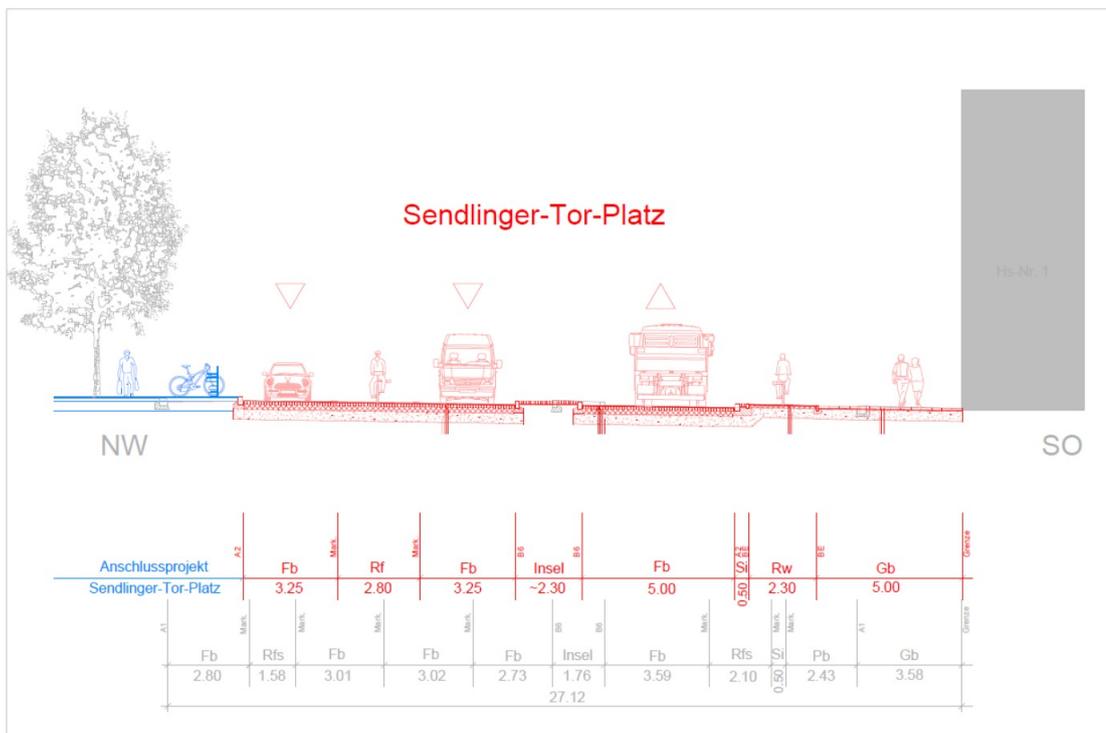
Querschnitt Bereich Stadtparkasse Variante 2 (vgl. auch Lageplan Anlage 2), Quelle: Landeshauptstadt München
